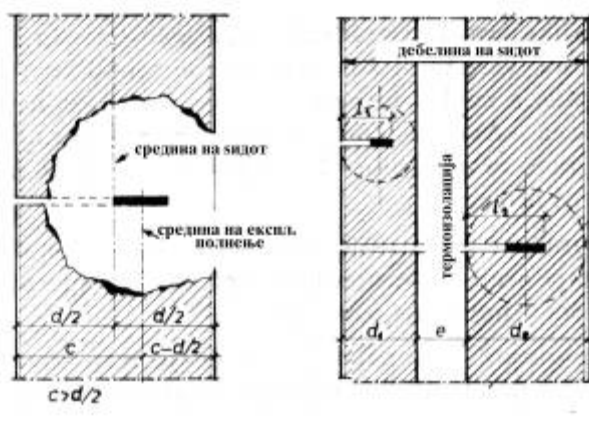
Размещение взрывчаток при разрушении двойных стен
